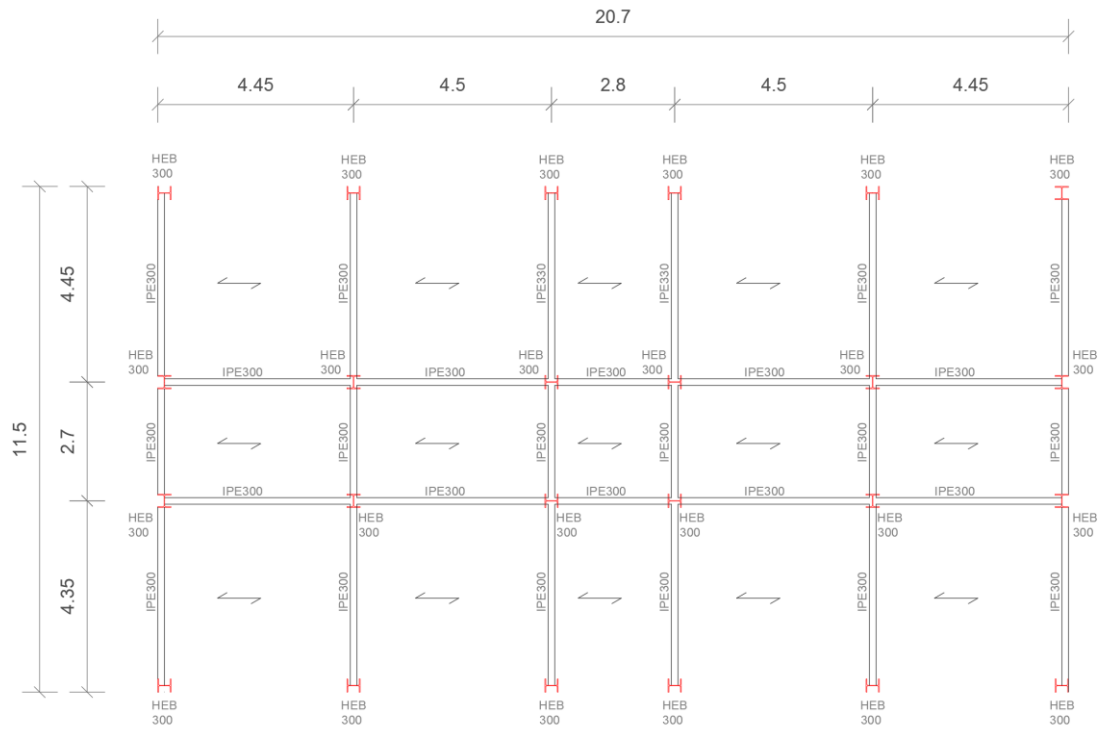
Carpenteria solaio di copertura struttura in acciaio a tre piani.
